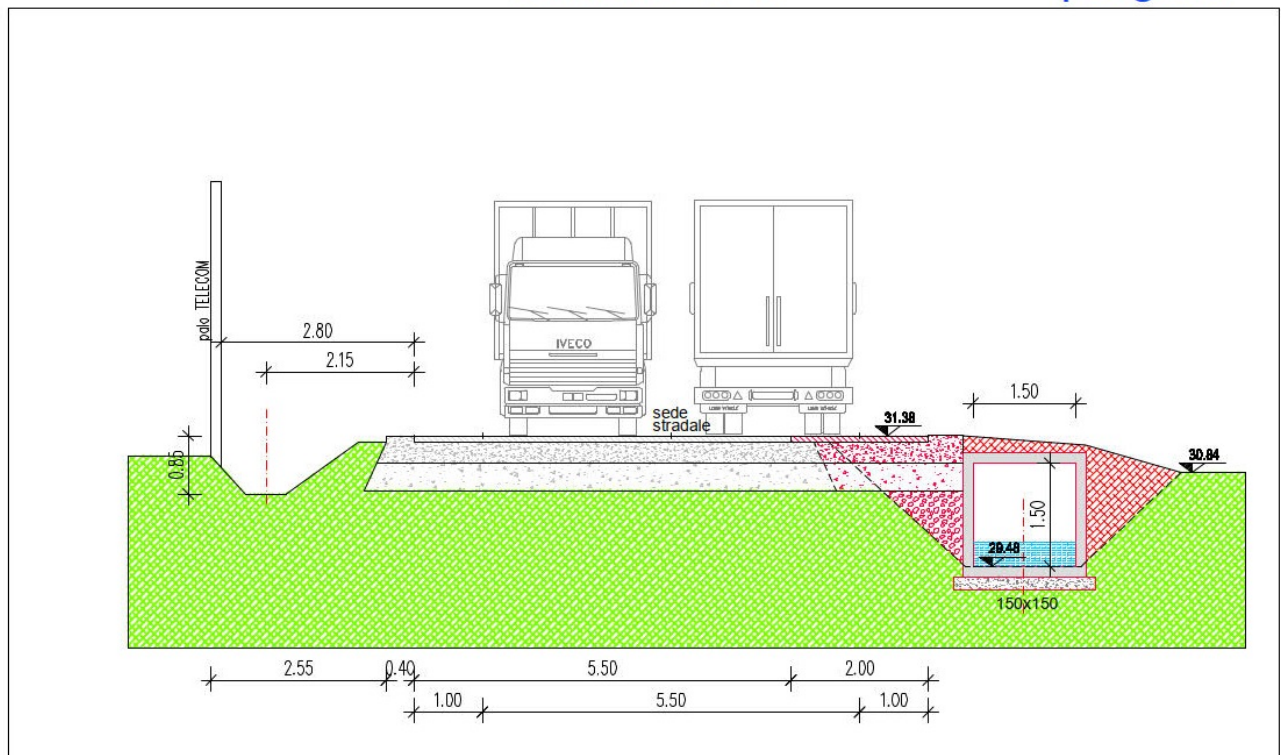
VIA CARPI - -riqualificazione e allargamento Via Carpi SEZIONE TIPO canale di Trignano
